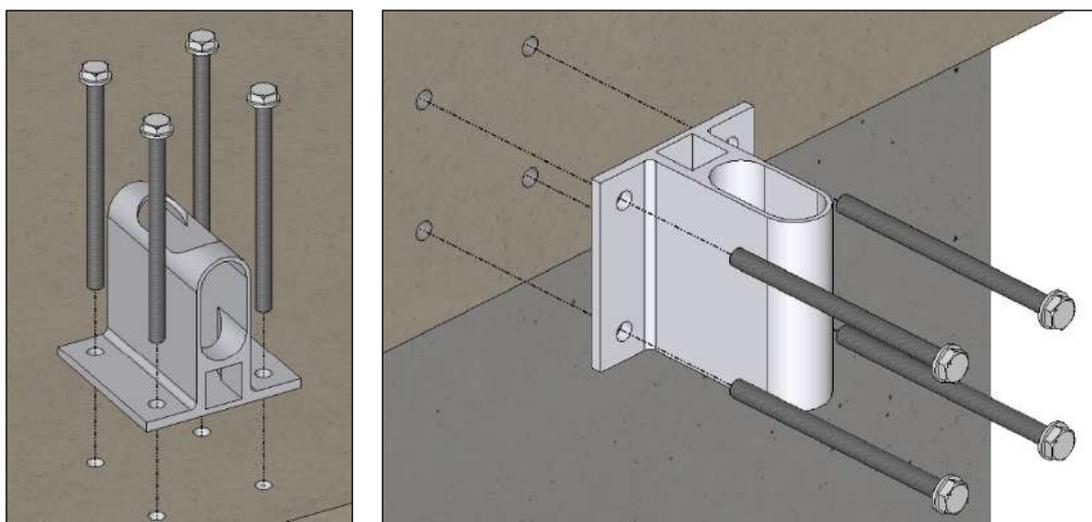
Fijación pie montante. A la izquierda fijación a suelo y a la derecha a pared.
